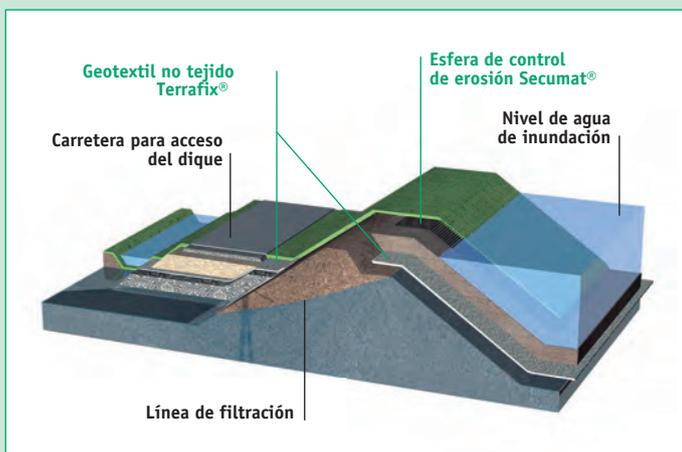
Sección transversal de un dique expuesto a la inundación con un filtro de carga, estabilizado con geotextile Terrafix® no tejido y plantillas de control de erosión Secumat®.
